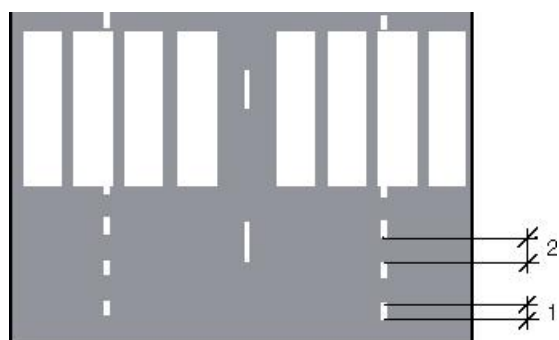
Bankantmarkering, banklass 5-6.
